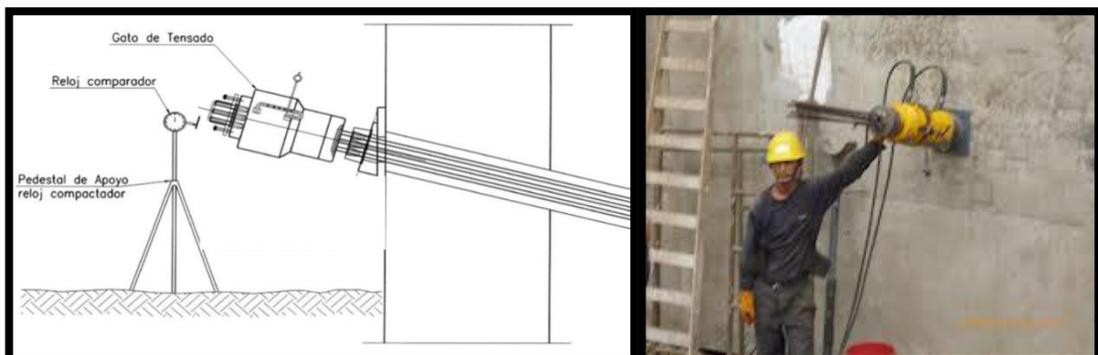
Tensado de los cables metálicos.
